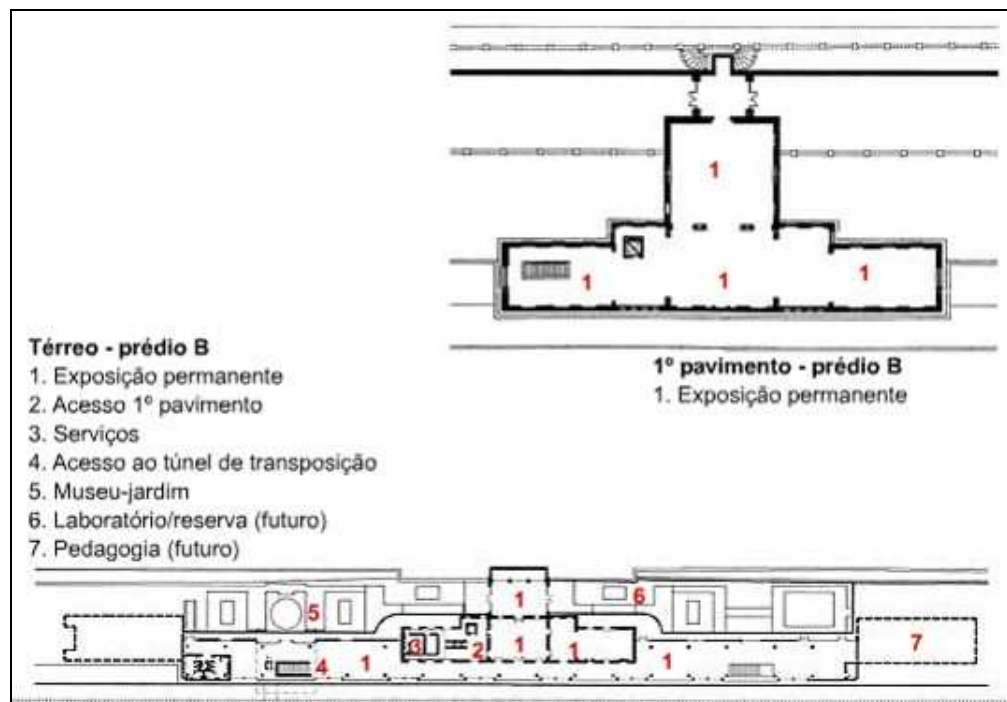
Planta do Prédio B – Estação Oeste de Minas.
